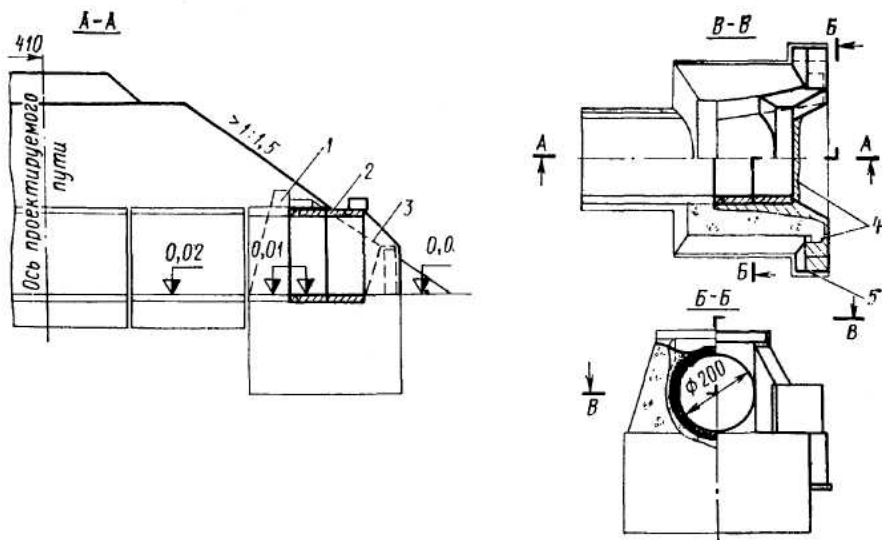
Удлинение круглой трубы со стороны выходного оголовка (размеры в сантиметрах): 1 – существующий оголовек; 2 – новые железобетонные звенья; 3 – новый бетонный оголовек; 4 – граница срубки существующего оголовка; 5 – блоки фундамента под крылья оголовка
